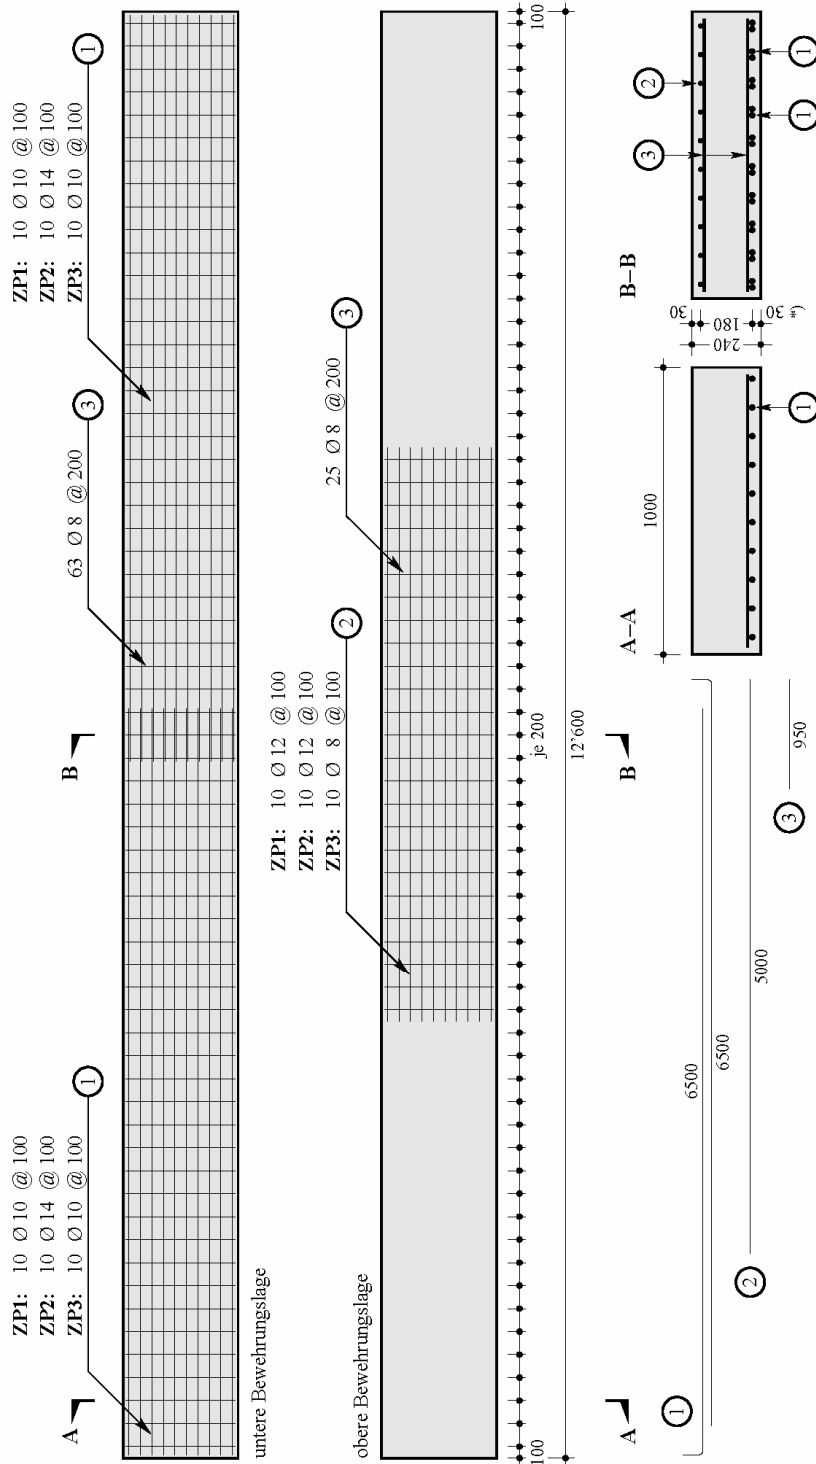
Bewehrungsführung der Versuchskörper ZP1, ZP2, ZP3 (aus [2])
